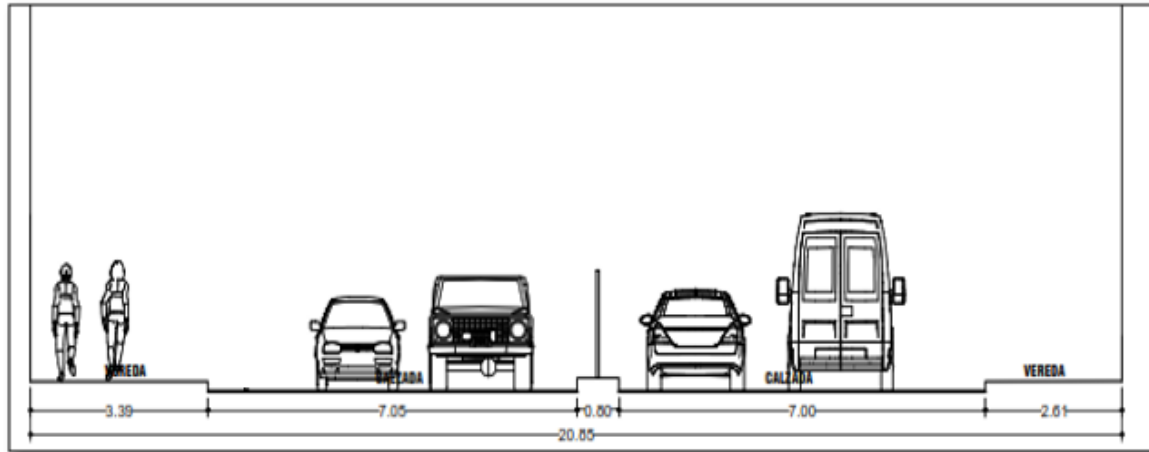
Av. Garcilazo situación actual, Corte 15-15
